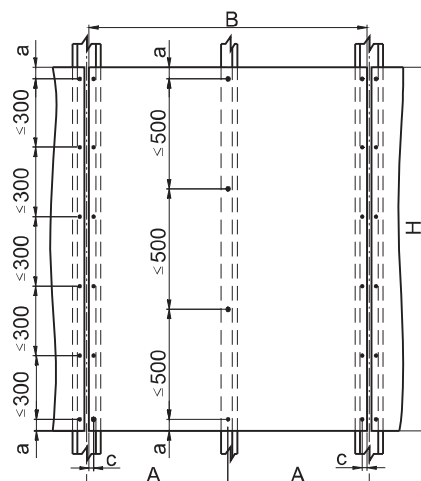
Схема крепления асбестоцементной панели при высоте здания свыше 12 этажей.
